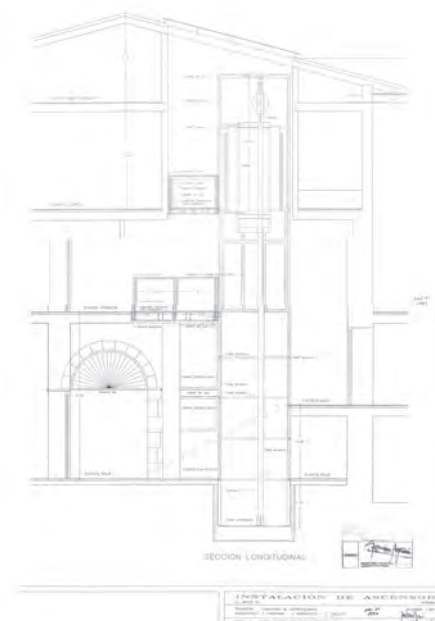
42. SECCIÓN LONGITUDINAL
